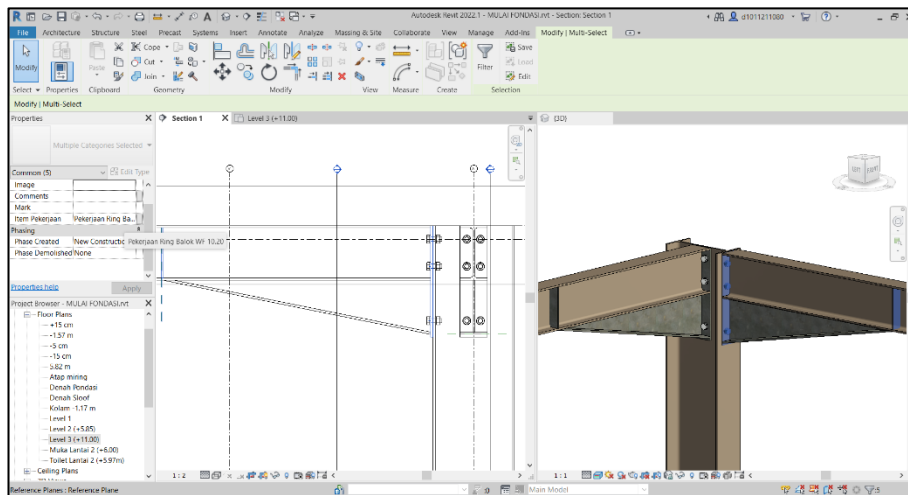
Pemodelan Sloof Beton dan Balok Baja
